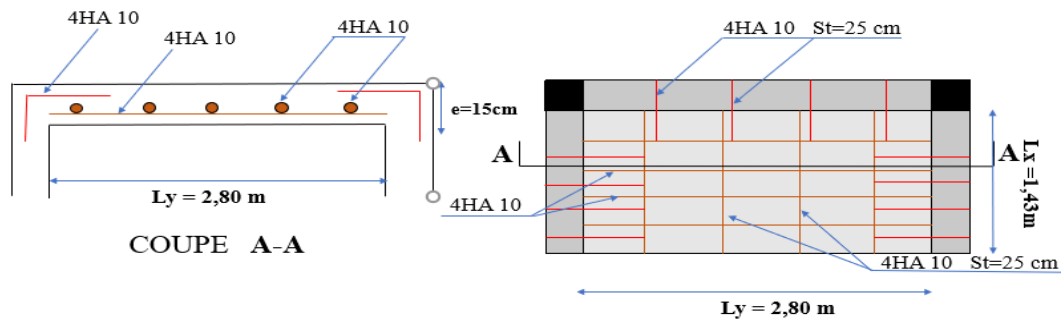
Schéma de ferrailage sur trois appuis (DP1).
